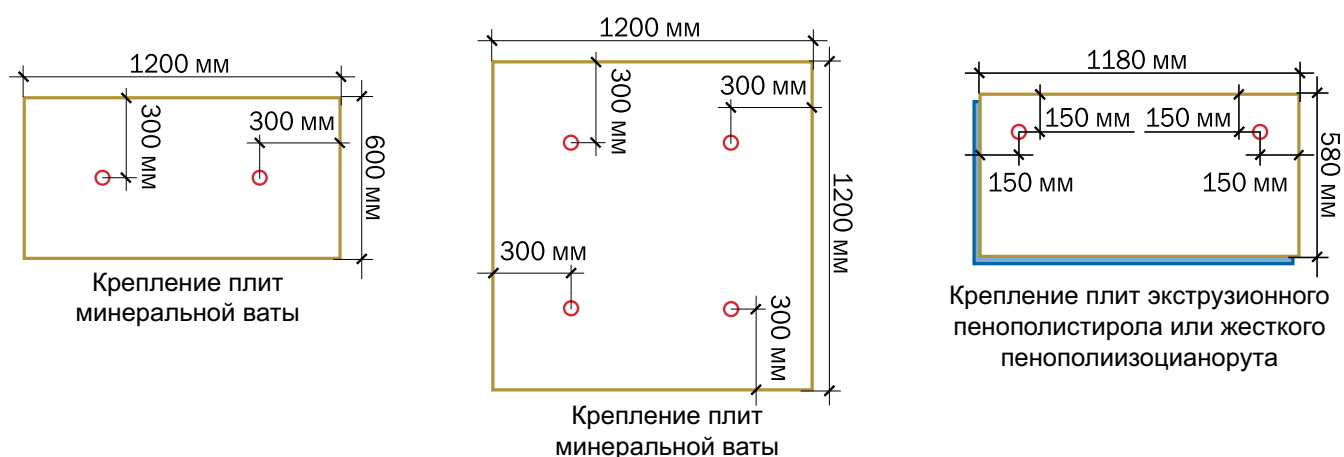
Схема крепления теплоизоляционных плит
